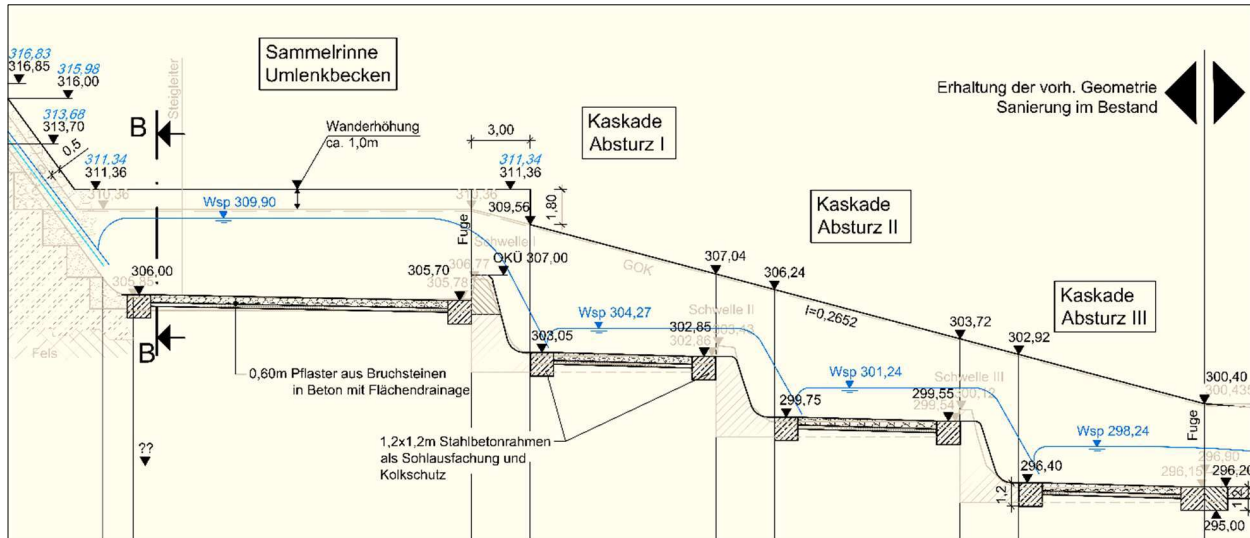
Variante A1/B1; HWE - oberer Abschnitt - Schnitt A; Ausschnitt aus Plan 423 HWE-Grundriss Schnitt A
